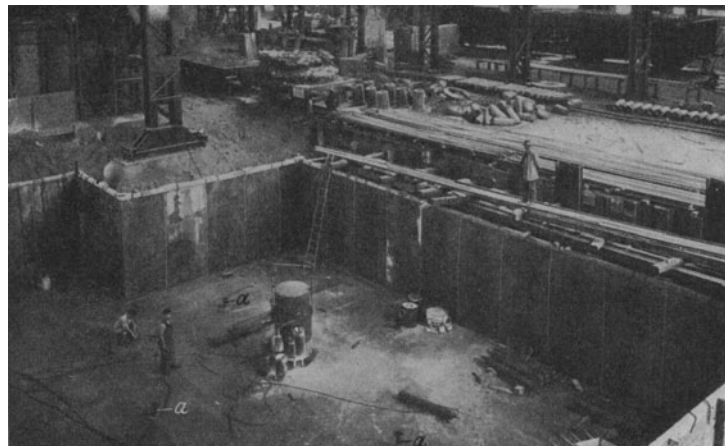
Grundwasserabdichtung durch eine verschweißte Eisenblechhaut im Grundwerk für einen Elektroofen in Spandau. (Siemens-Bau-Union.)
